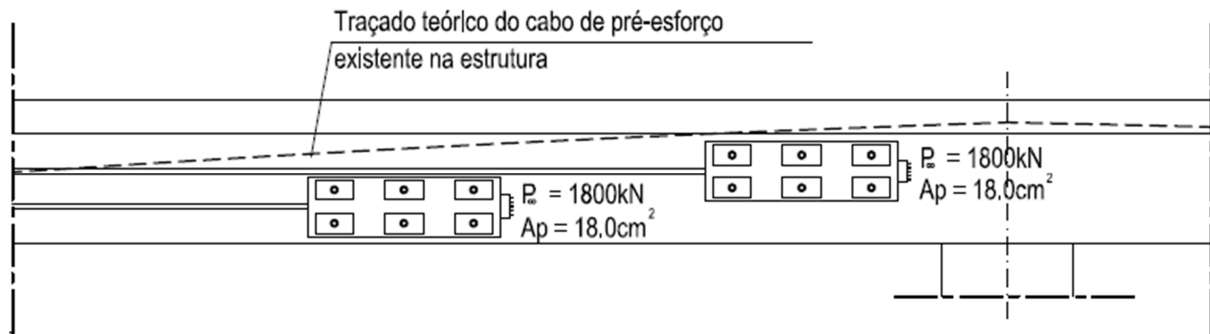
Traçado do cabo de pré-esforço exterior.
